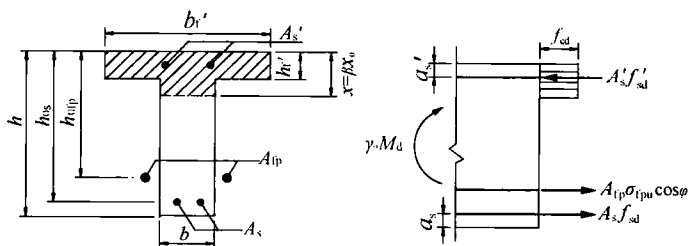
体外预应力 FRP 钢筋混凝土受弯构件正截面承载力计算
